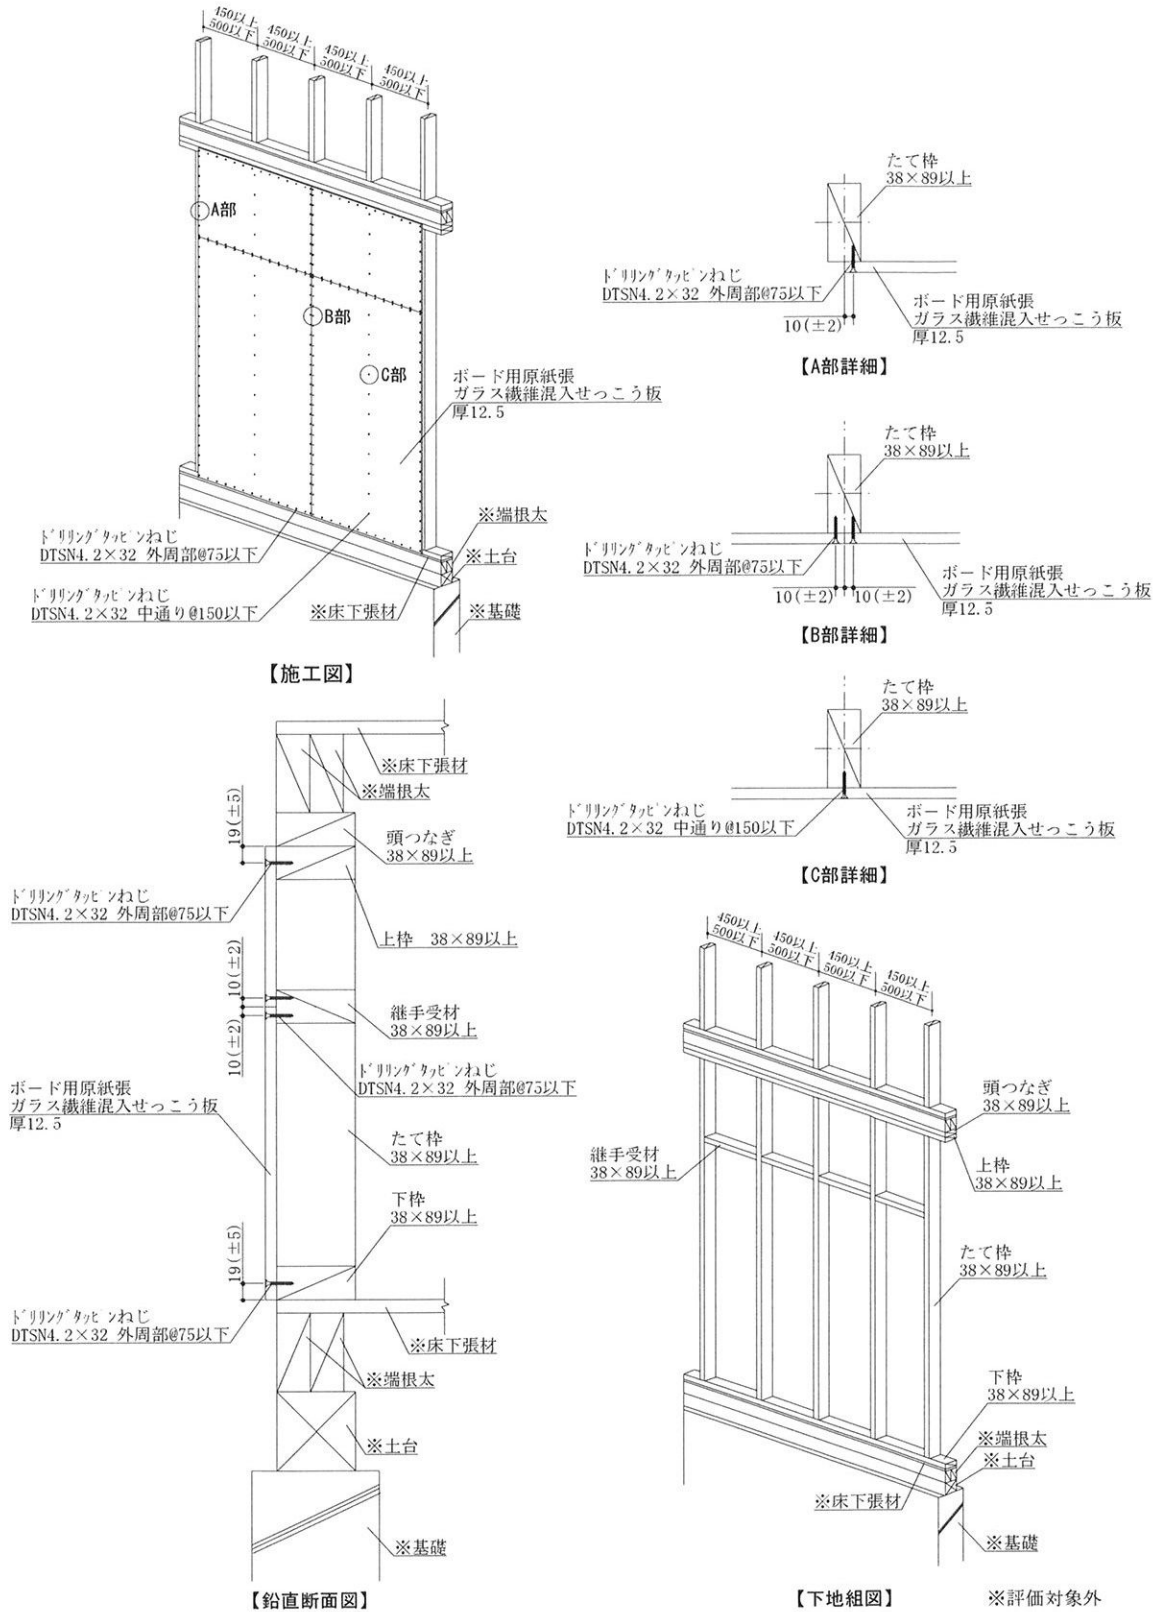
施工詳細図：縦継ぎ張りの場合 (寸法単位：mm)
